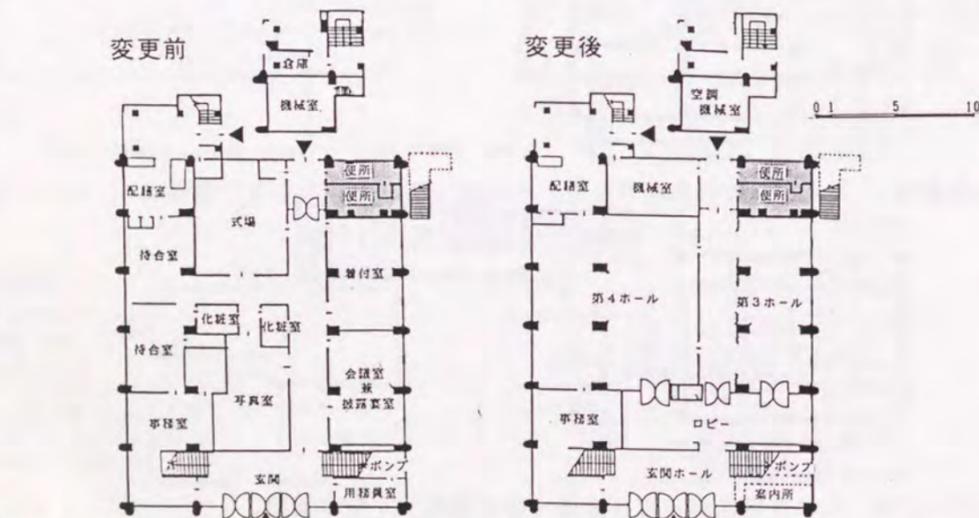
<63>足立区産業振興館集会室(旧結婚式場)平面図
